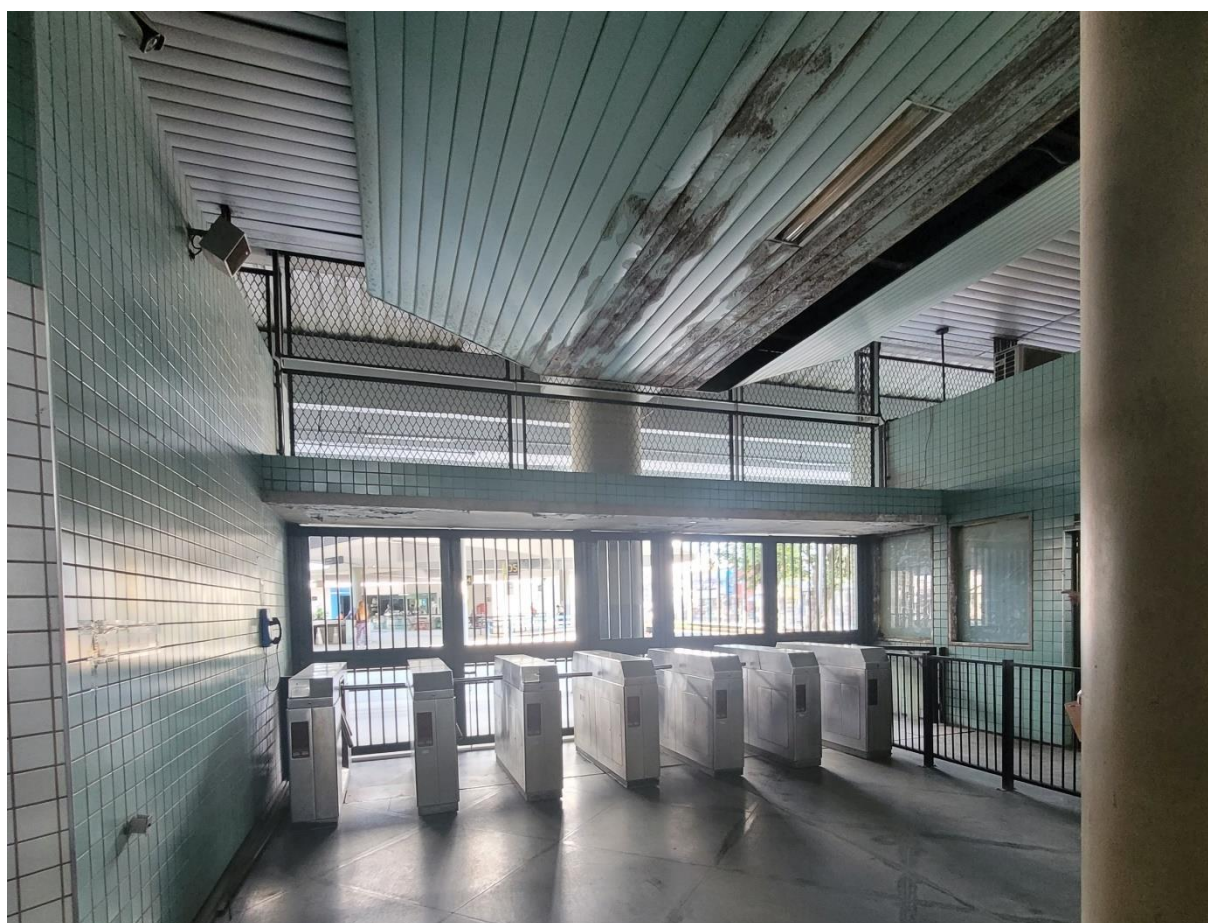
Infiltração sobre o forro em perfis metálicos (saguão)
